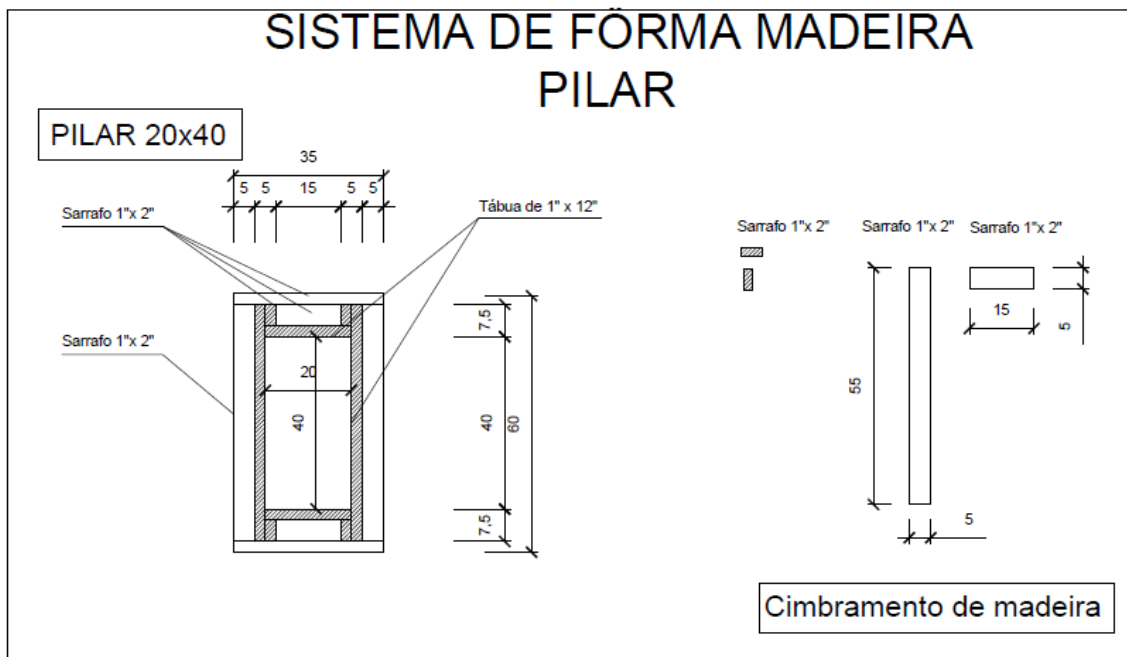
Modelo 03 de fôrma para pilar de concreto armado.
